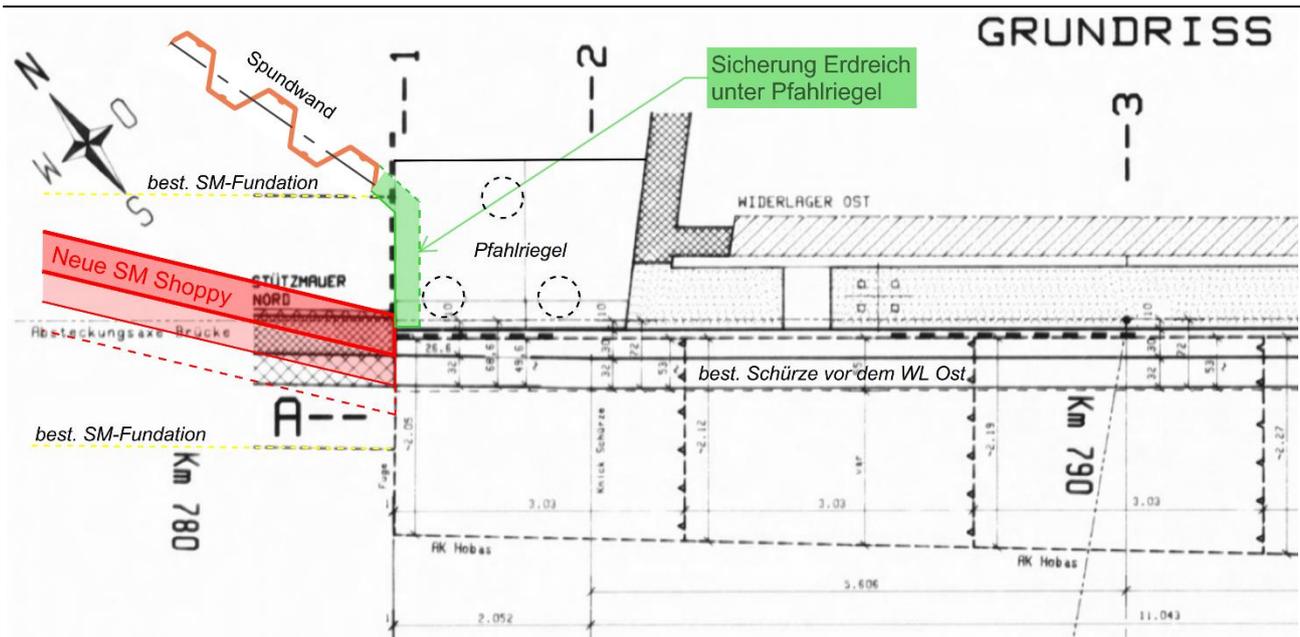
Grundriss Anschluss neue SM Shoppy an UEF SBB im Sand
